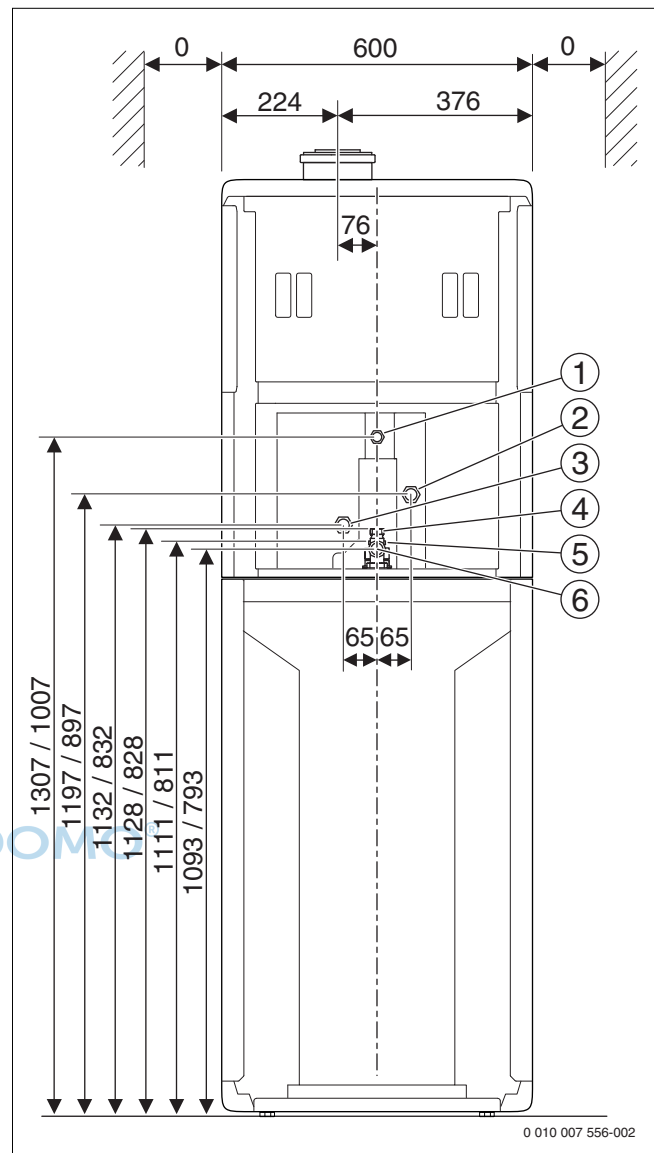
Abmessungen und Anschlüsse ohne Zubehör
